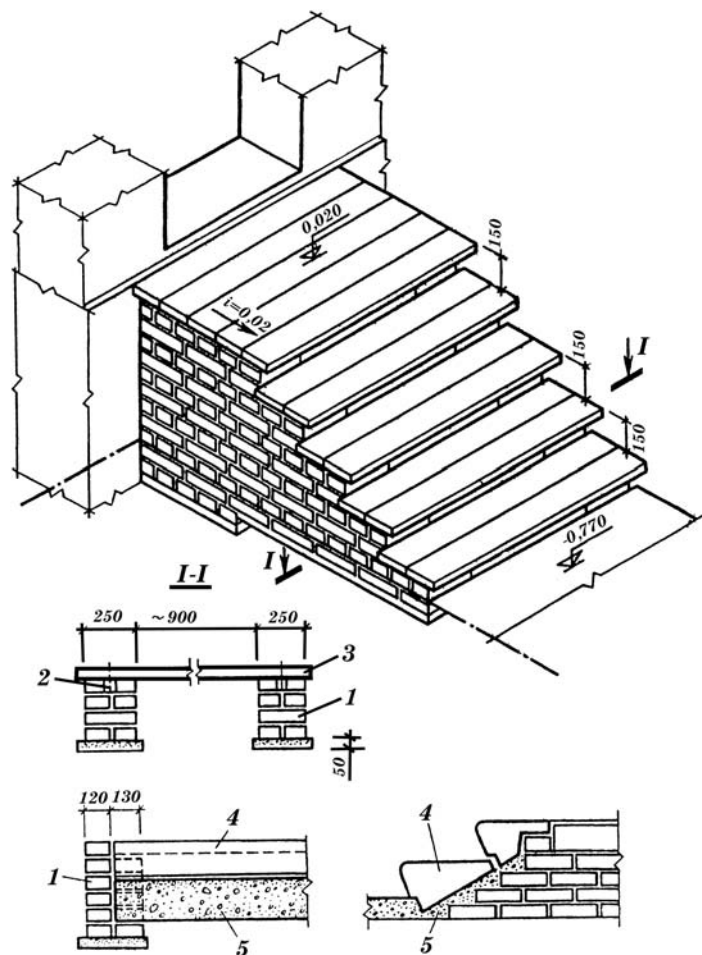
Крыльцо на кирпичном фундаменте: 1 – кирпичные опоры под ступени; 2 – деревянные пробки для крепления деревянных ступеней; 3 – деревянные ступени; 4 – железобетонные ступени; 5 – цементный раствор; а – детали укладки железобетонных ступеней.
